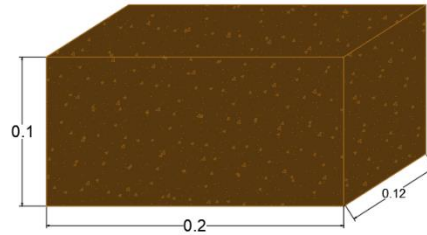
Dimensiones Mampuesto Ecológico. Elaboración Propia
